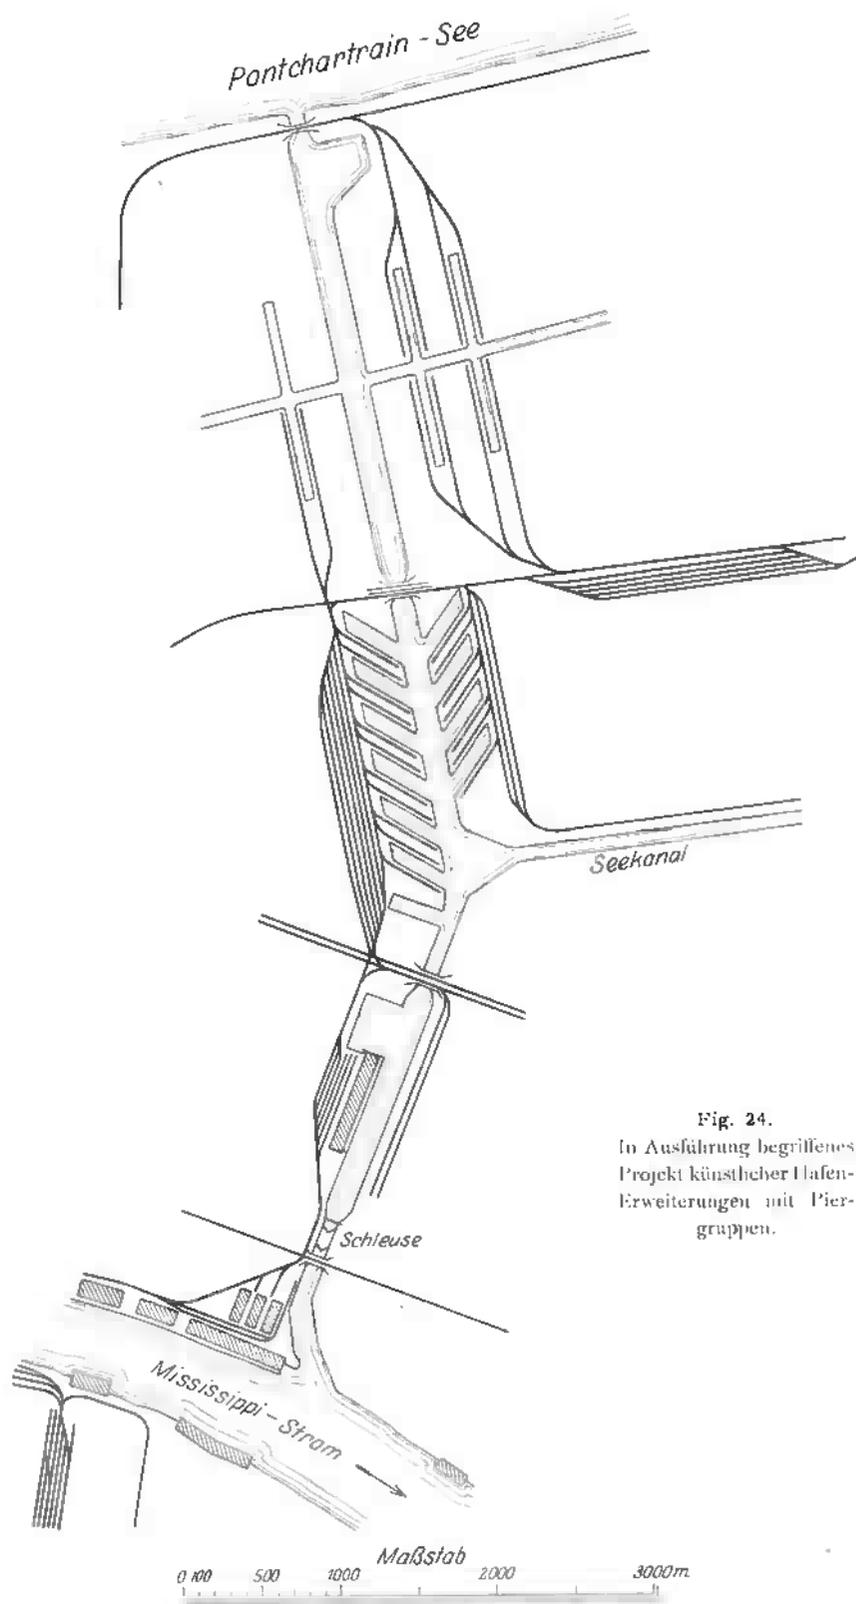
In Ausführung begriffenes Projekt künstlicher Hafenerweiterungen mit Piergruppen.
